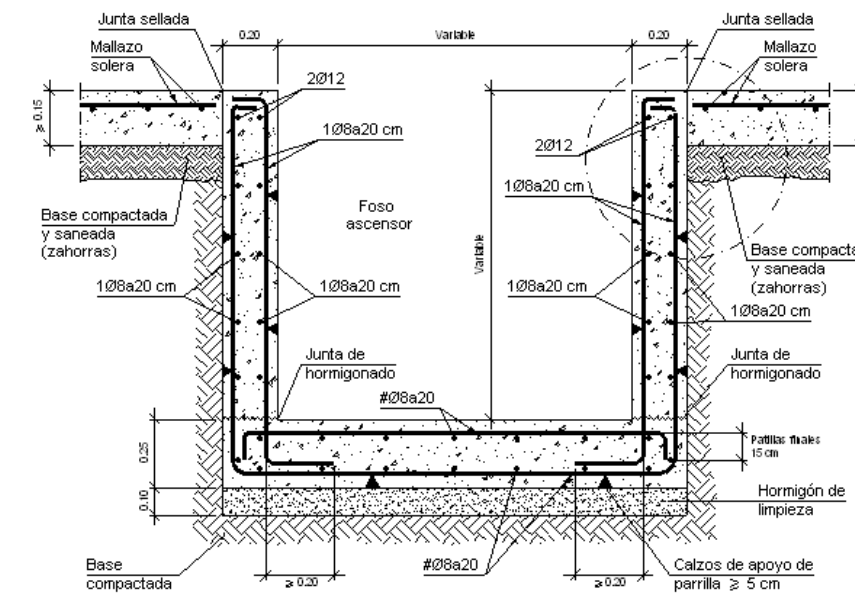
Detalle de foso de ascensor. (Detalle constructivo cype)
